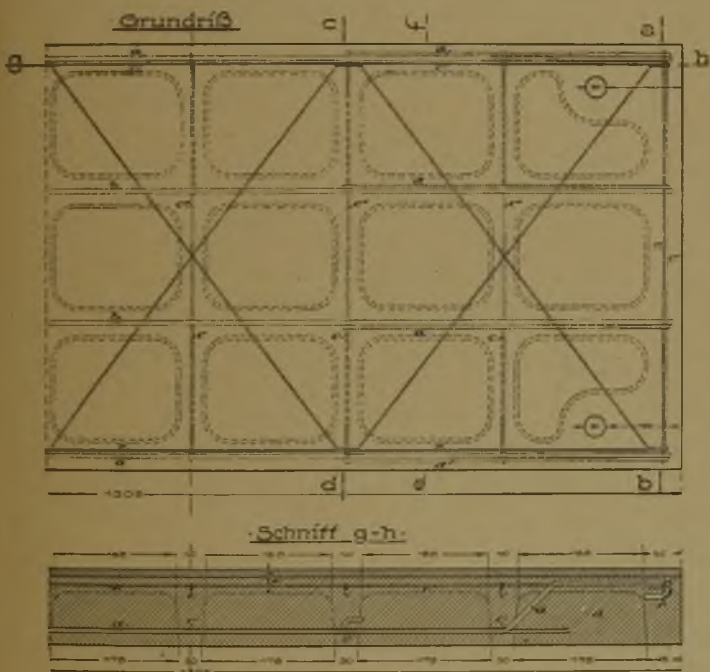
3. Grundriß und Schnitte der Gehwegplatten.
